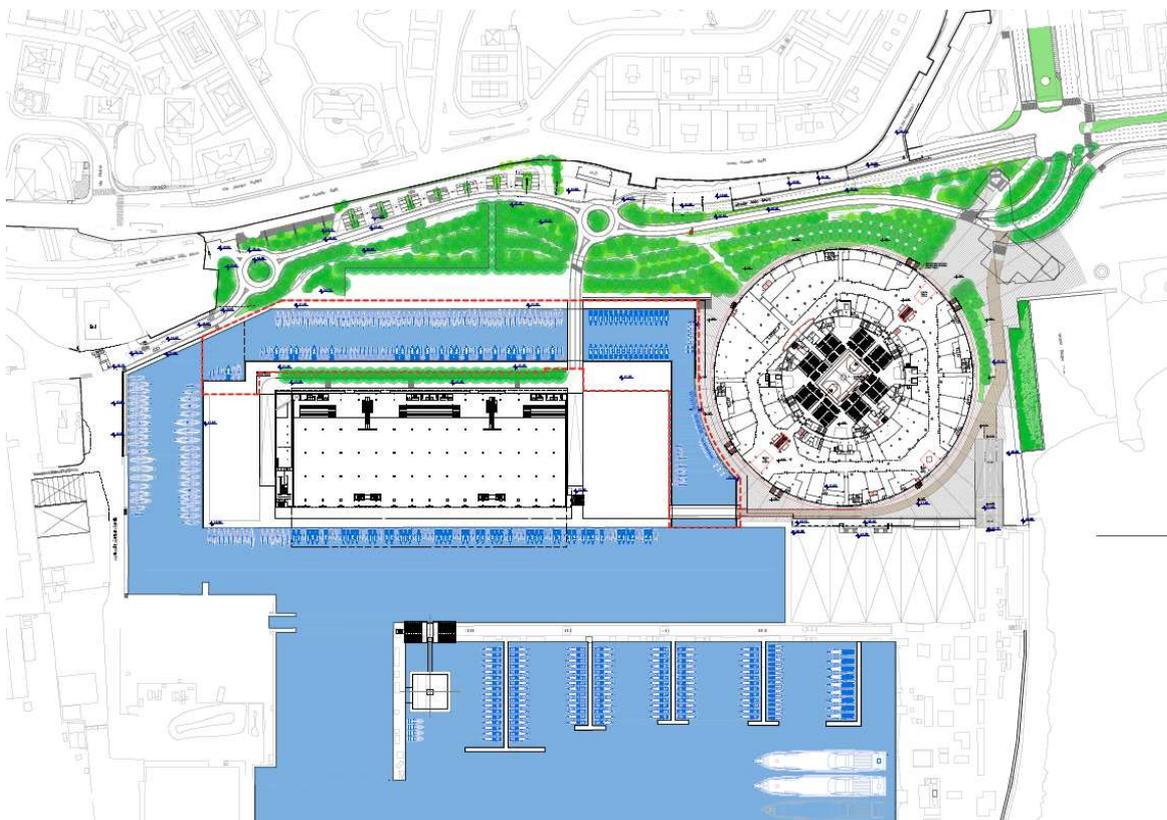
Stato di progetto. Planimetria generale a quota +5,20 (Stralcio elaborato T04-D-Ar del progetto definitivo).
